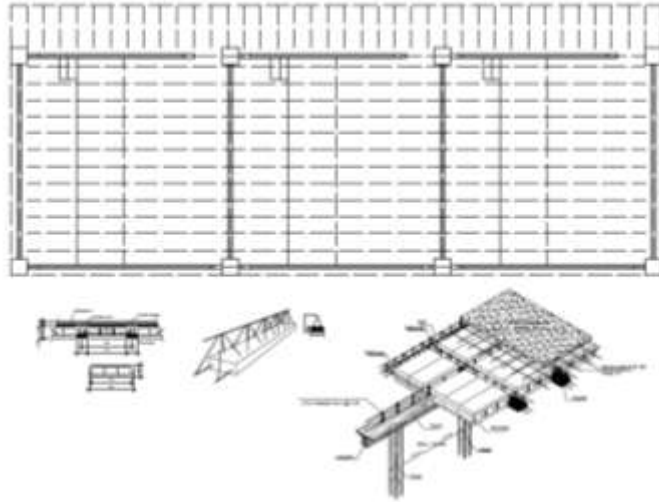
ESTRUCTURA PRINCIPAL DEL EDIFICIO
